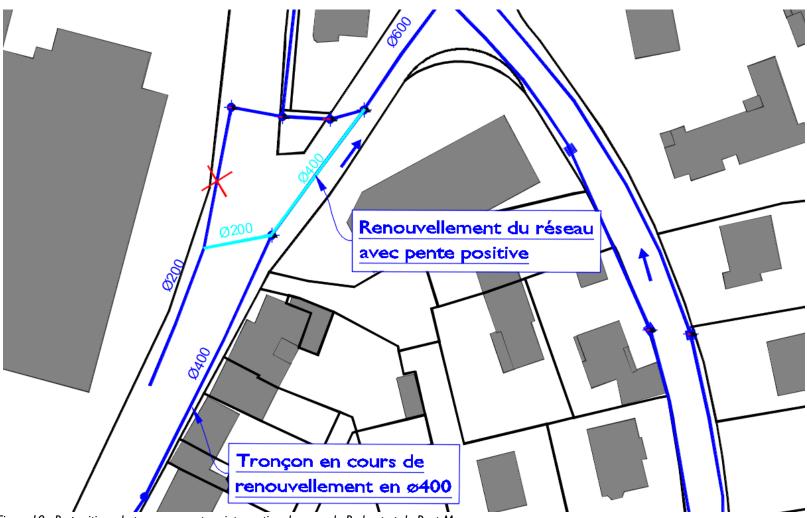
Propositions de travaux – secteur intersection des rues du Porhoet et du Pont Mareuc
